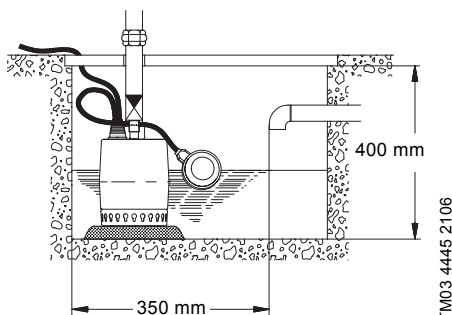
Dimensioni min. pozzo per Unilift KP-A
